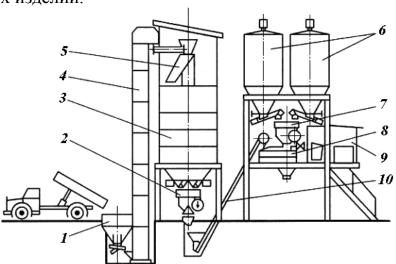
Схема двухступенчатой бетоносмесительной установки: 1 – приемный бункер; 2 – дозатор песка и щебня; 3 – расходный бункер; 4 – многоковшовый конвейер; 5 – поворотная воронка; 6 – силосы цемента; 7 – дозатор цемента; 8 – бетоносмеситель; 9 – кабина управления; 10 – скиповый подъемник
